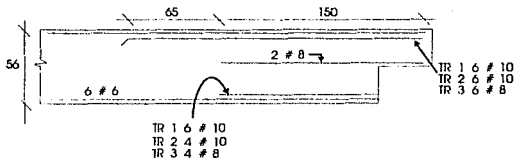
DETALLE EN LOS EXTREMOS DE LAS TRAVES DE RIGIDEZ
